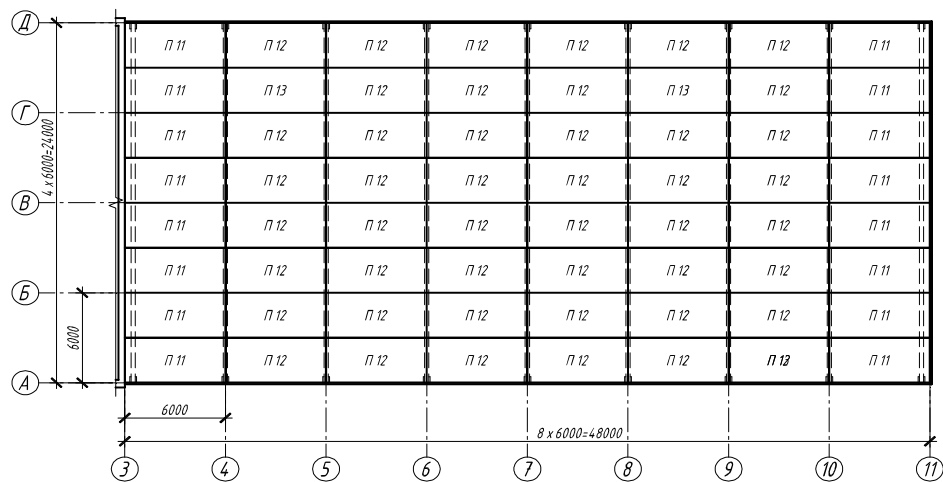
Схема розташування плит перекриття на відм. +4,800
